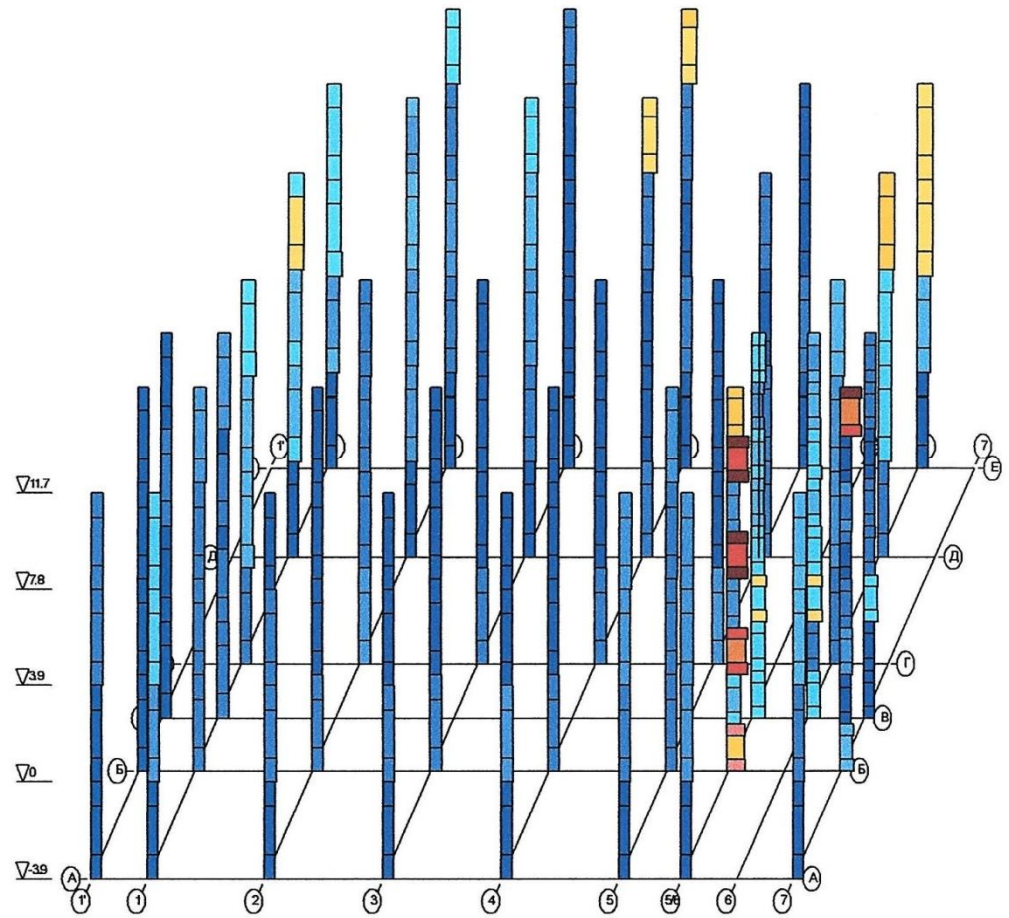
Необхідні площі поздовжньої симетричної арматури у колонах,
